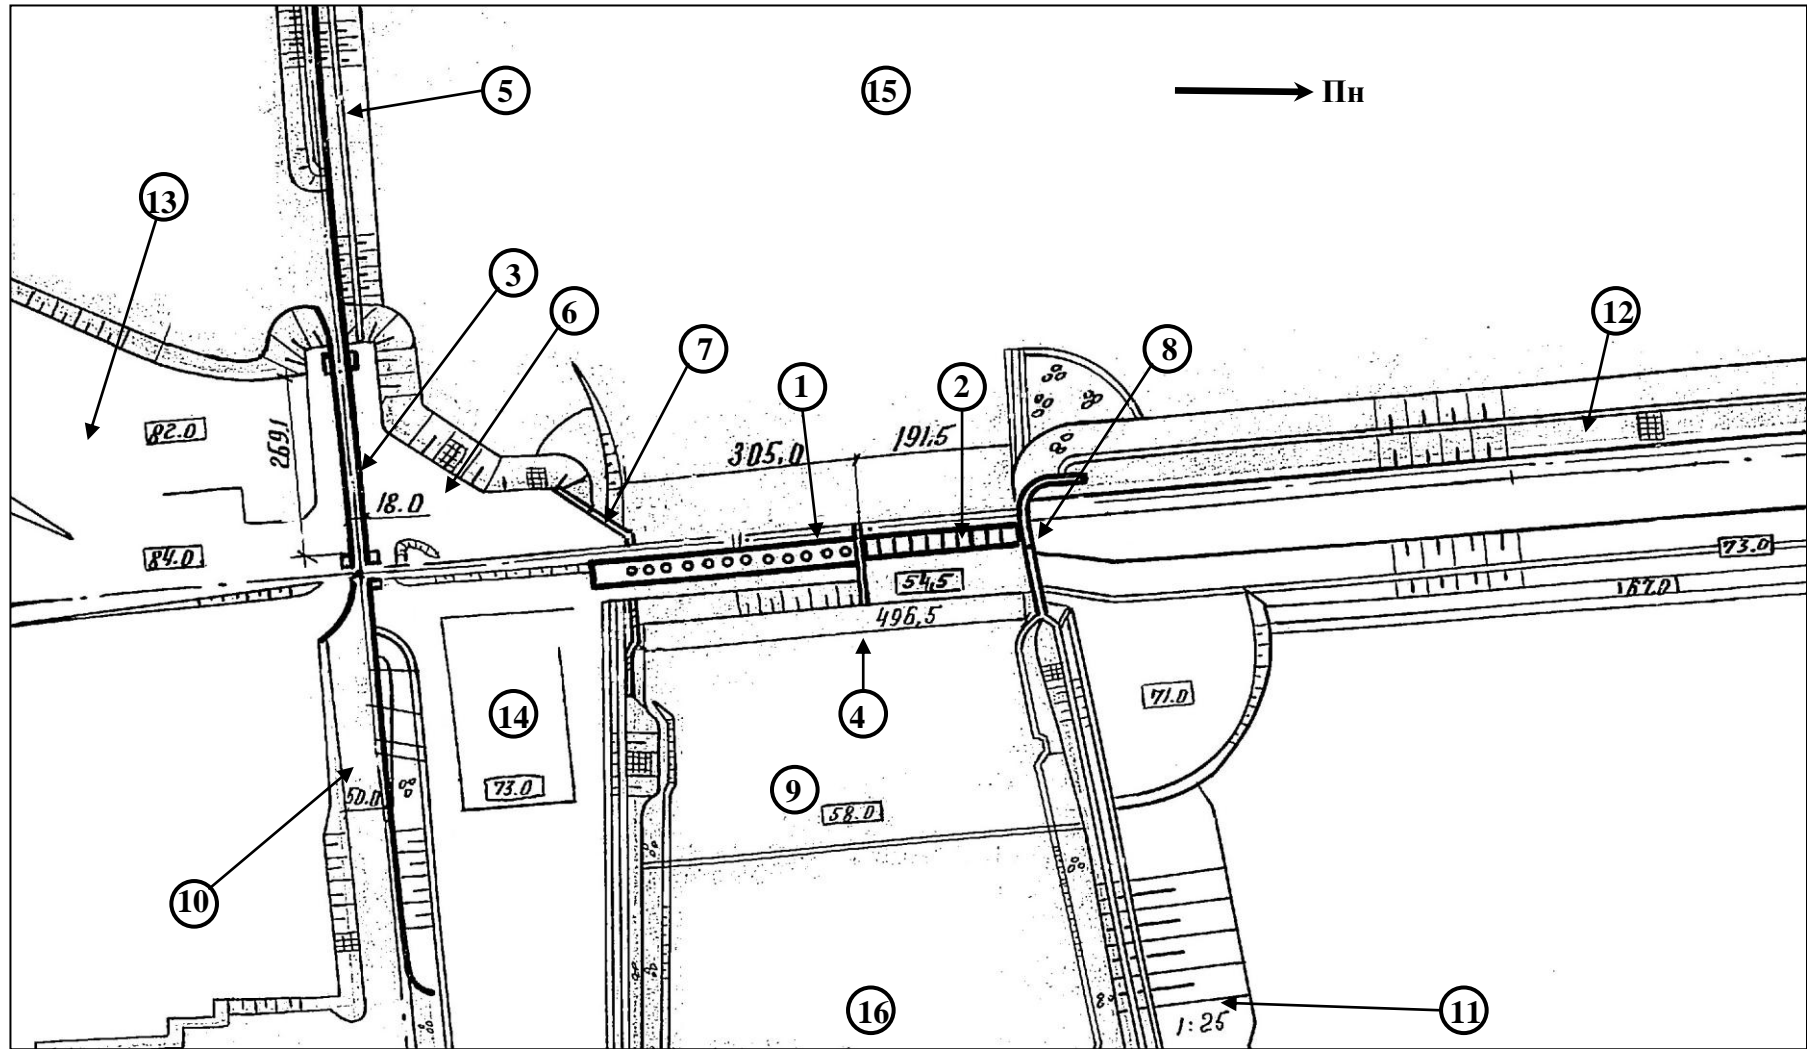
Фрагмент плану Кременчуцького гідровузла: 1 – будівля гідроелектростанції; 2 – бетонна водозливна гребля; 3 – шлюз; 4 – роздільний бик; 5 – причальна споруда верхового підходу; 6 – земляна вставка між шлюзом і будівлею гідроелектростанції; 7 – правобережний стоян; 8 – лівобережний стоян; 9 – відводящий канал гідроелектростанції і водозливної греблі; 10 – причальна споруда низового підходу; 11 – огорожуюча дамба; 12 – лівобережна гребля; 13 – правобережна гребля; 14 – відкритий розподільчий пристрій; 15 – Кременчуцьке водосховище; 16 – нижній б'єф (розміри в м.)
